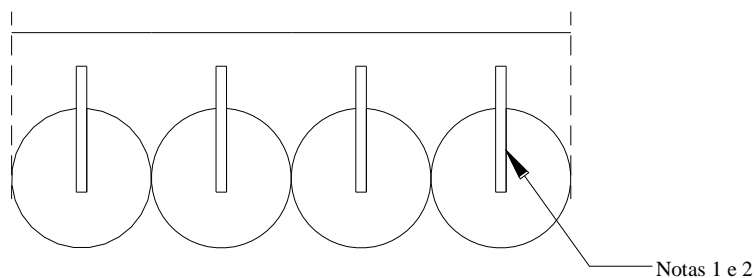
Secção transversal do sistema de ligação (secção AA).
